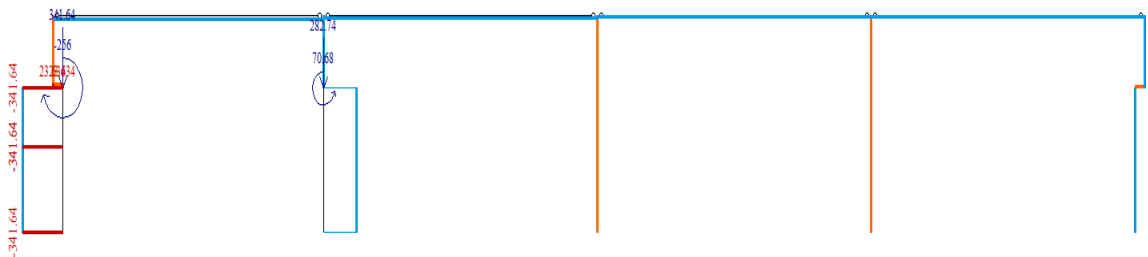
Епюра поздовжніх сил (N) від кранового навантаження
